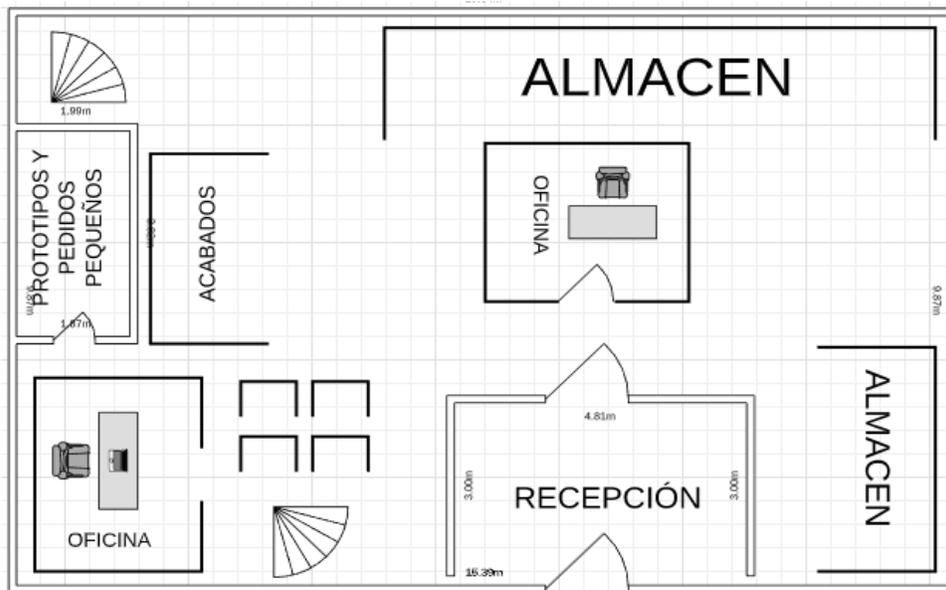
Plano actual segundo piso. Autoría propia (2020).
